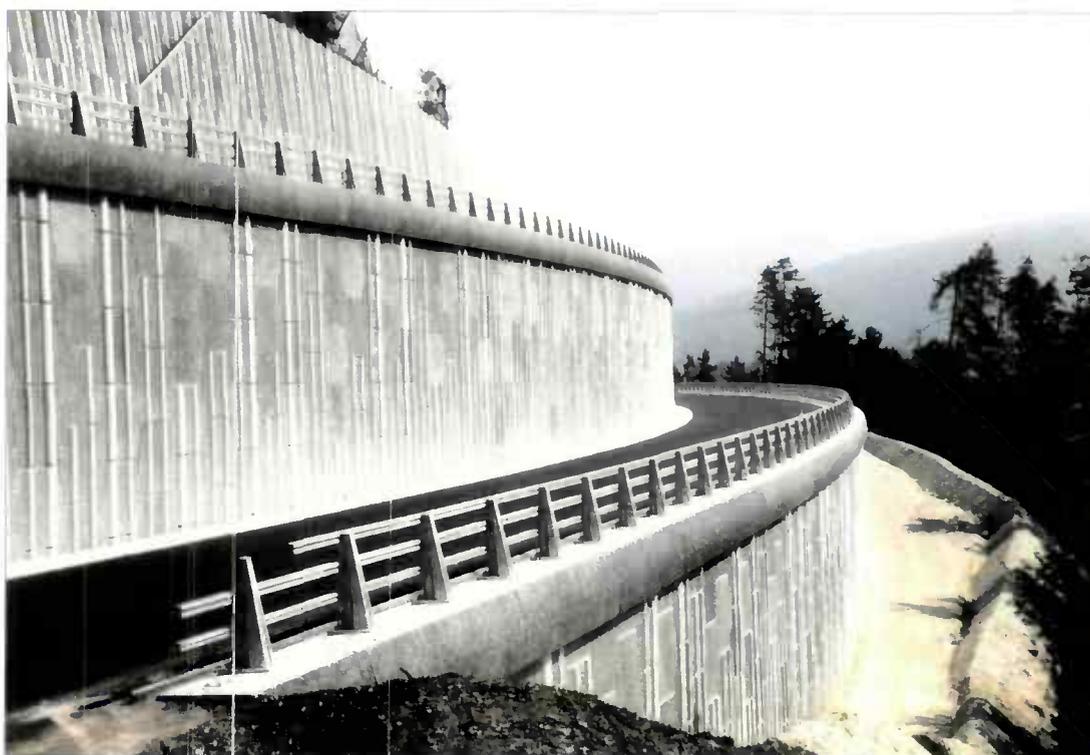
Exemple d'ouvrages de soutènement «complexes»
